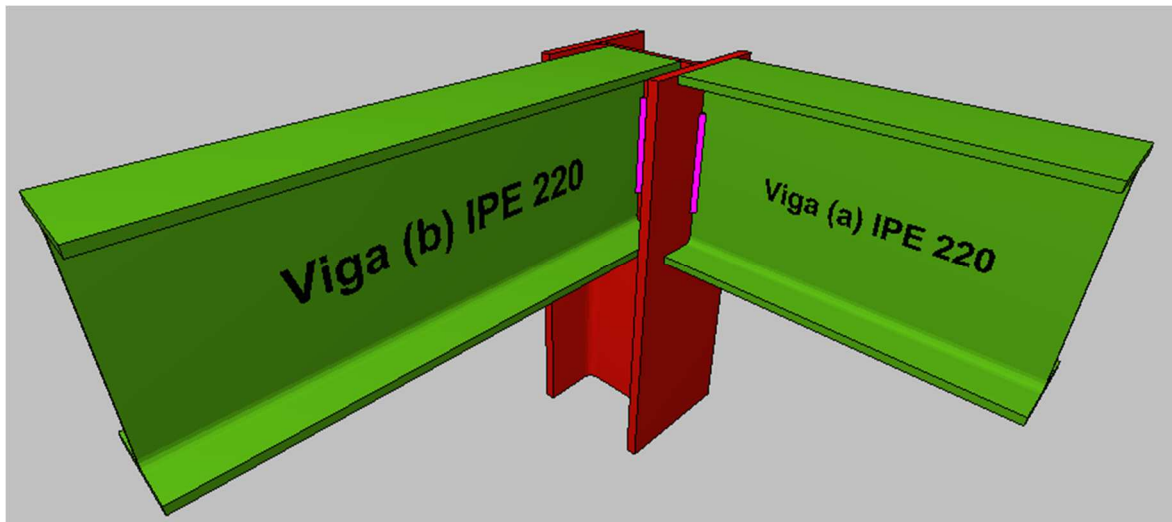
Unión tipo 4 soporte inferior. Viga-pilar-viga
